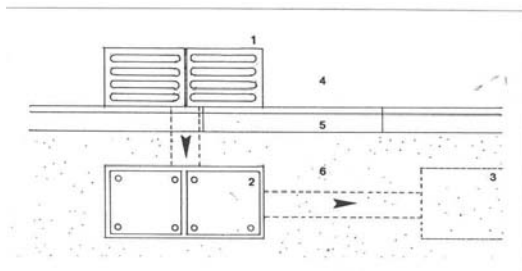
1.- Sumidero, 2.- Cámara, 3.- Zanja, 4.- Cuneta, 5.- Solera, 6.- Tubería de conexión.
